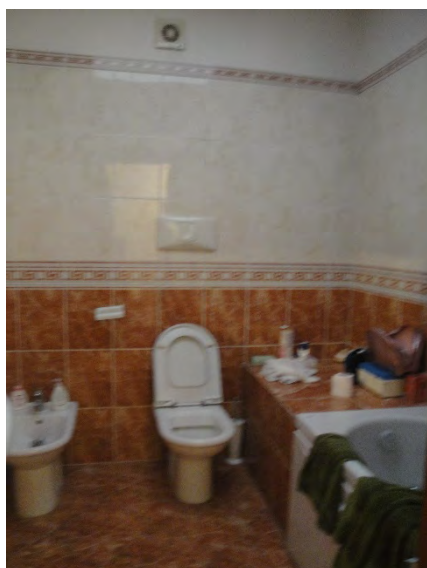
Piano primo viste delle camere e del bagno
